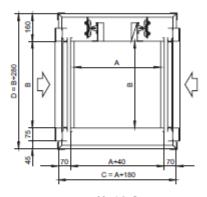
Dimensiones en Planta. Tipo de Instalación: Estructura Portante.
